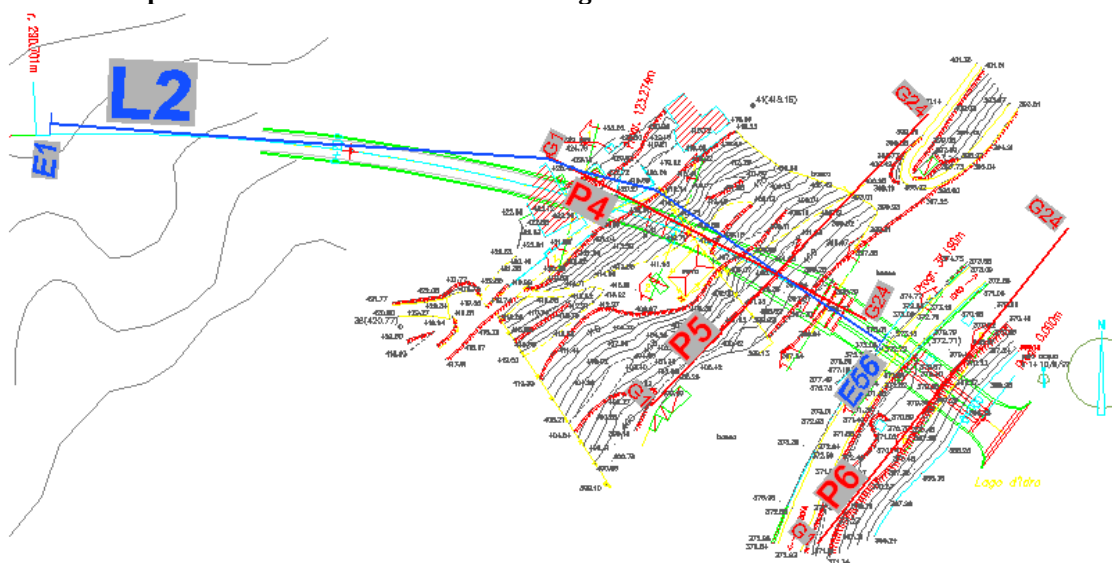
Stralci planimetrici con ubicazione delle indagini svolte all'imbocco a Idro.
